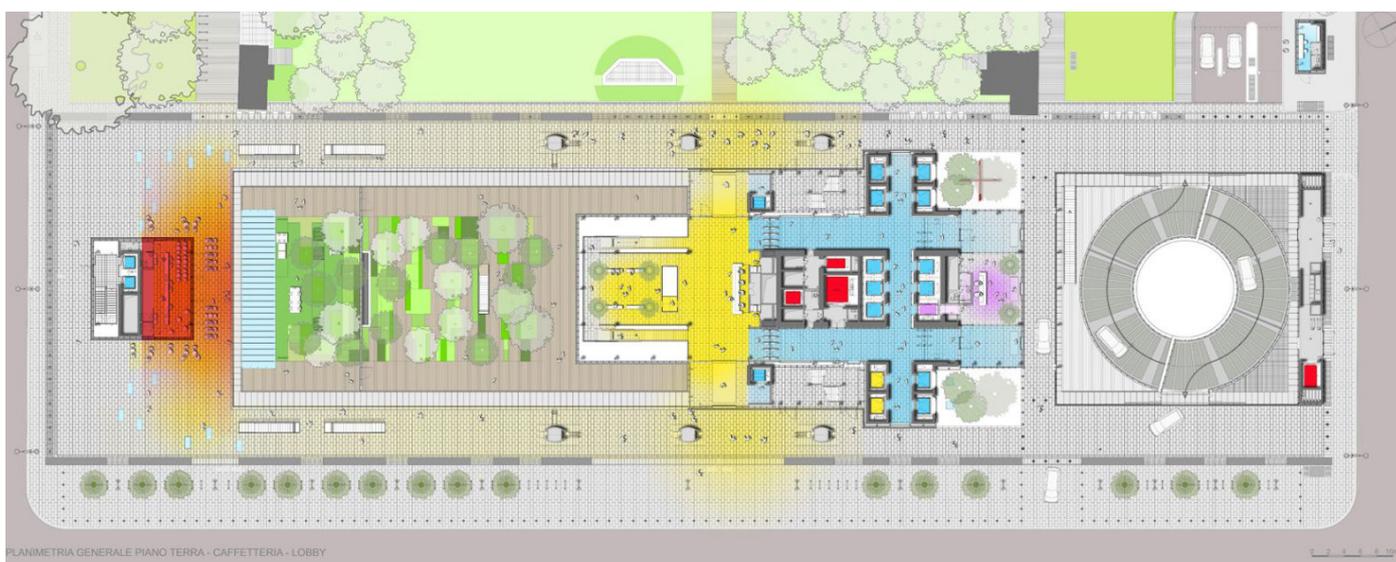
Planta baja Oficinas Intesa Sanpaolo.
